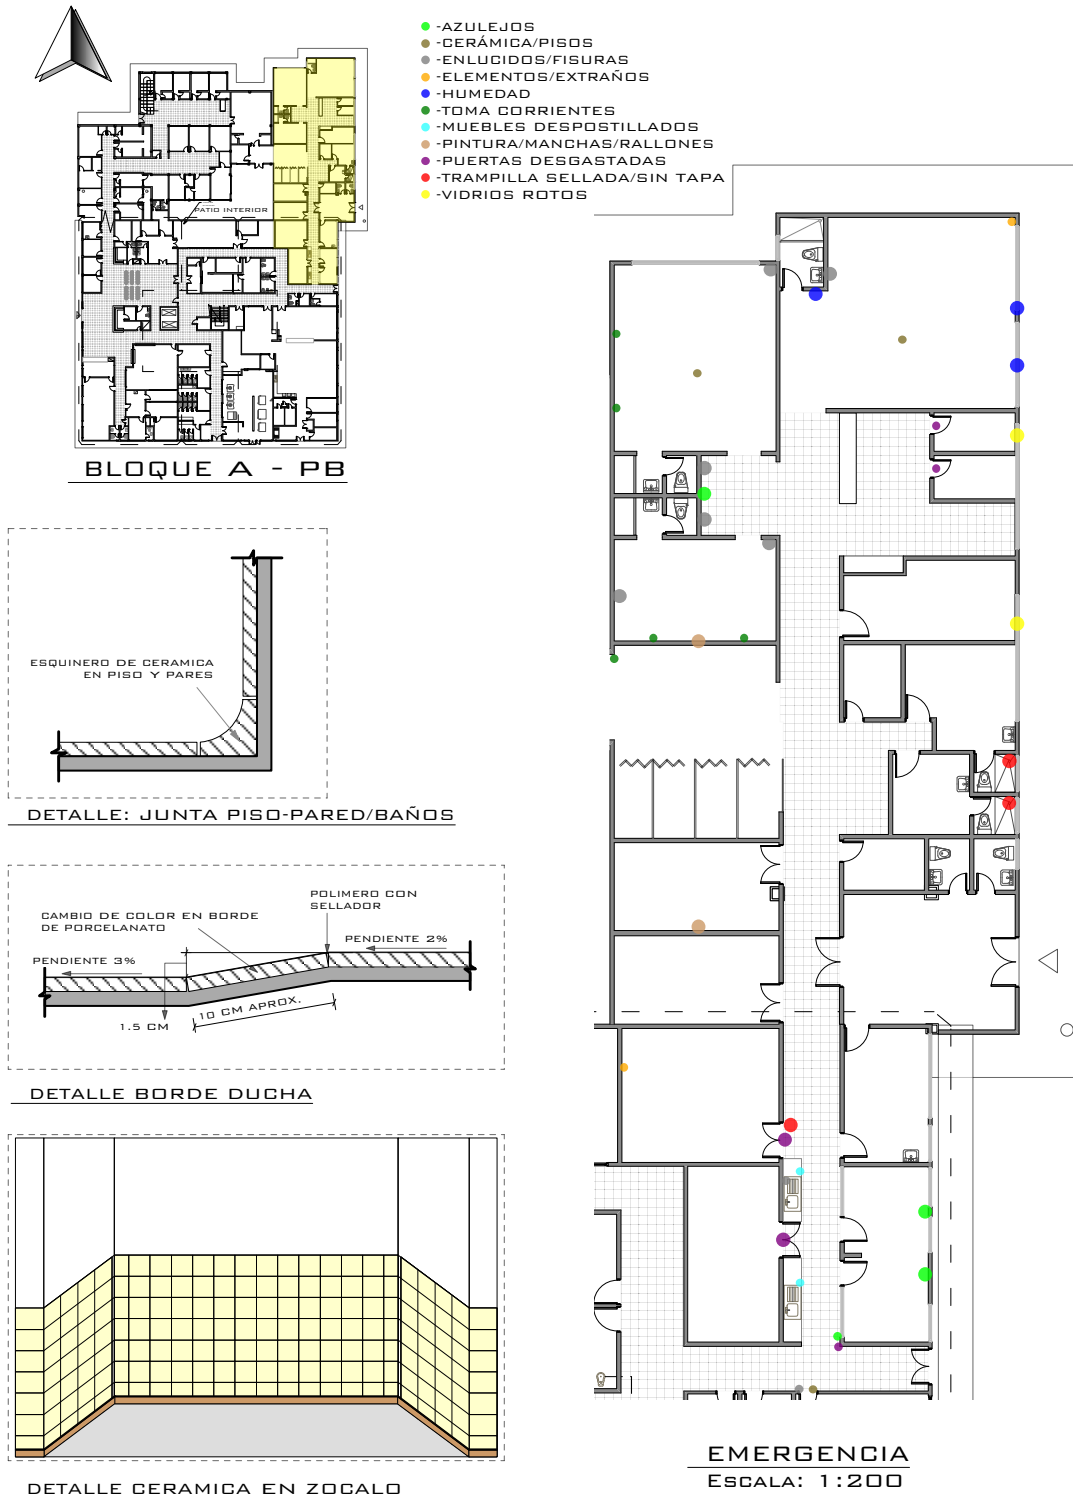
Plano de mapeo en el Área de emergencia
